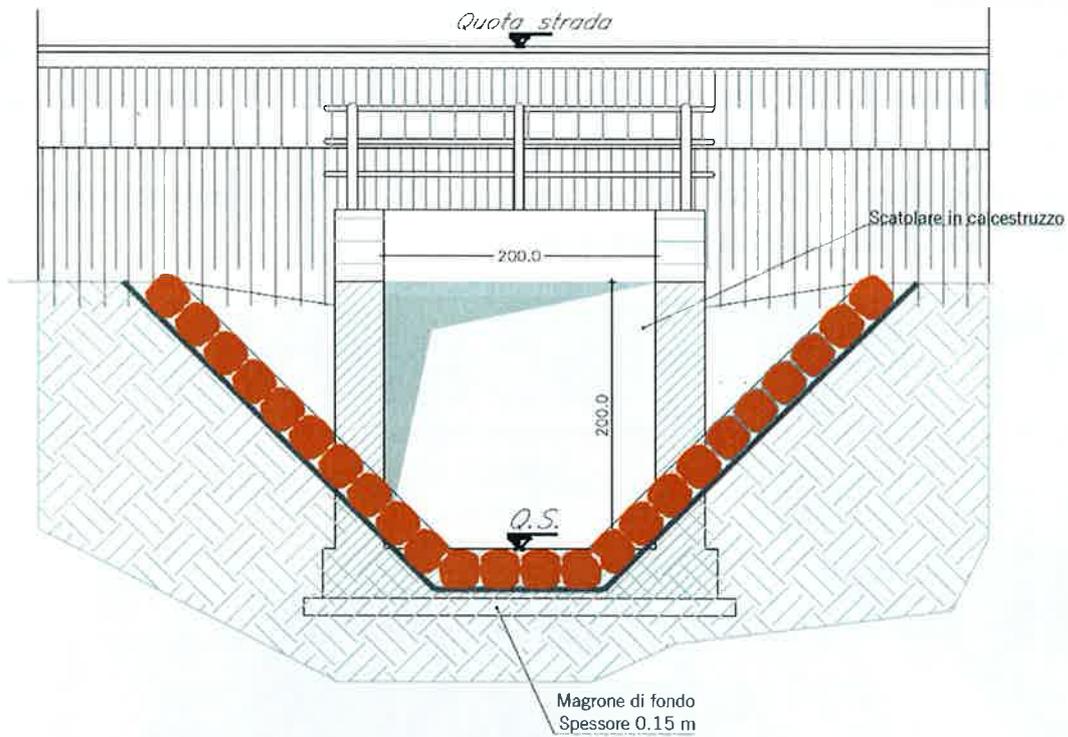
Inalveazione IN03 – tombino di attraversamento allo sbocco nel canale a sezione trapezia.
